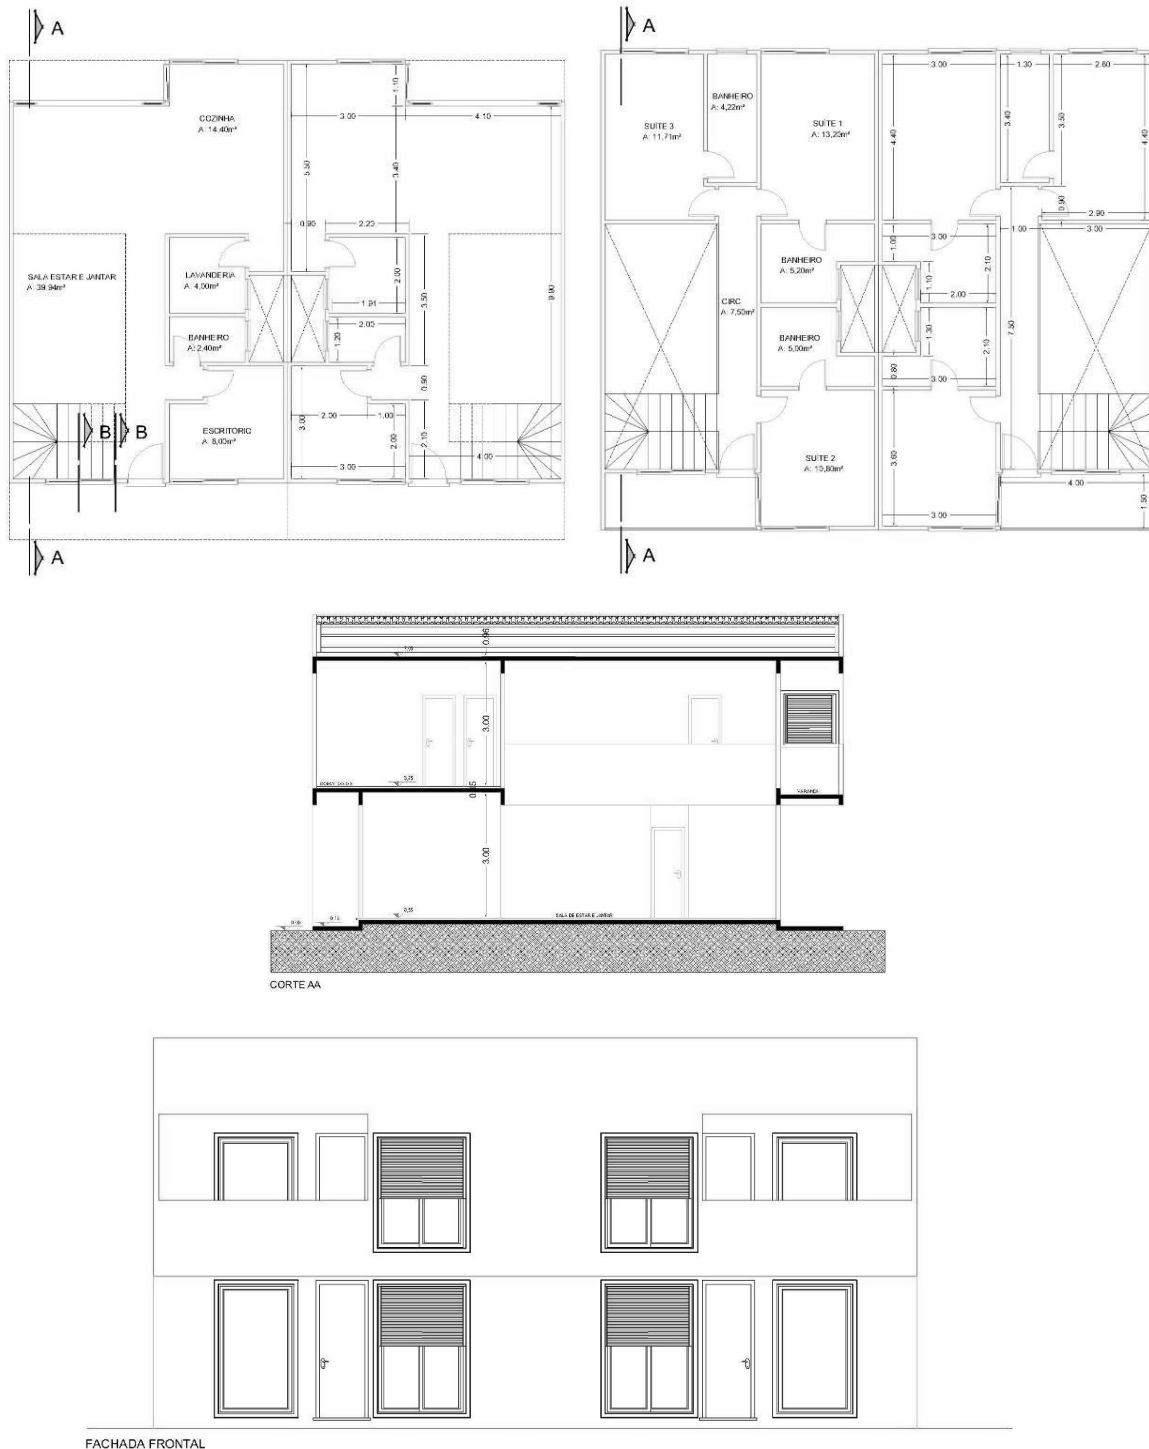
Planta baixa, corte e fachada principal da edificação tipo UH3
